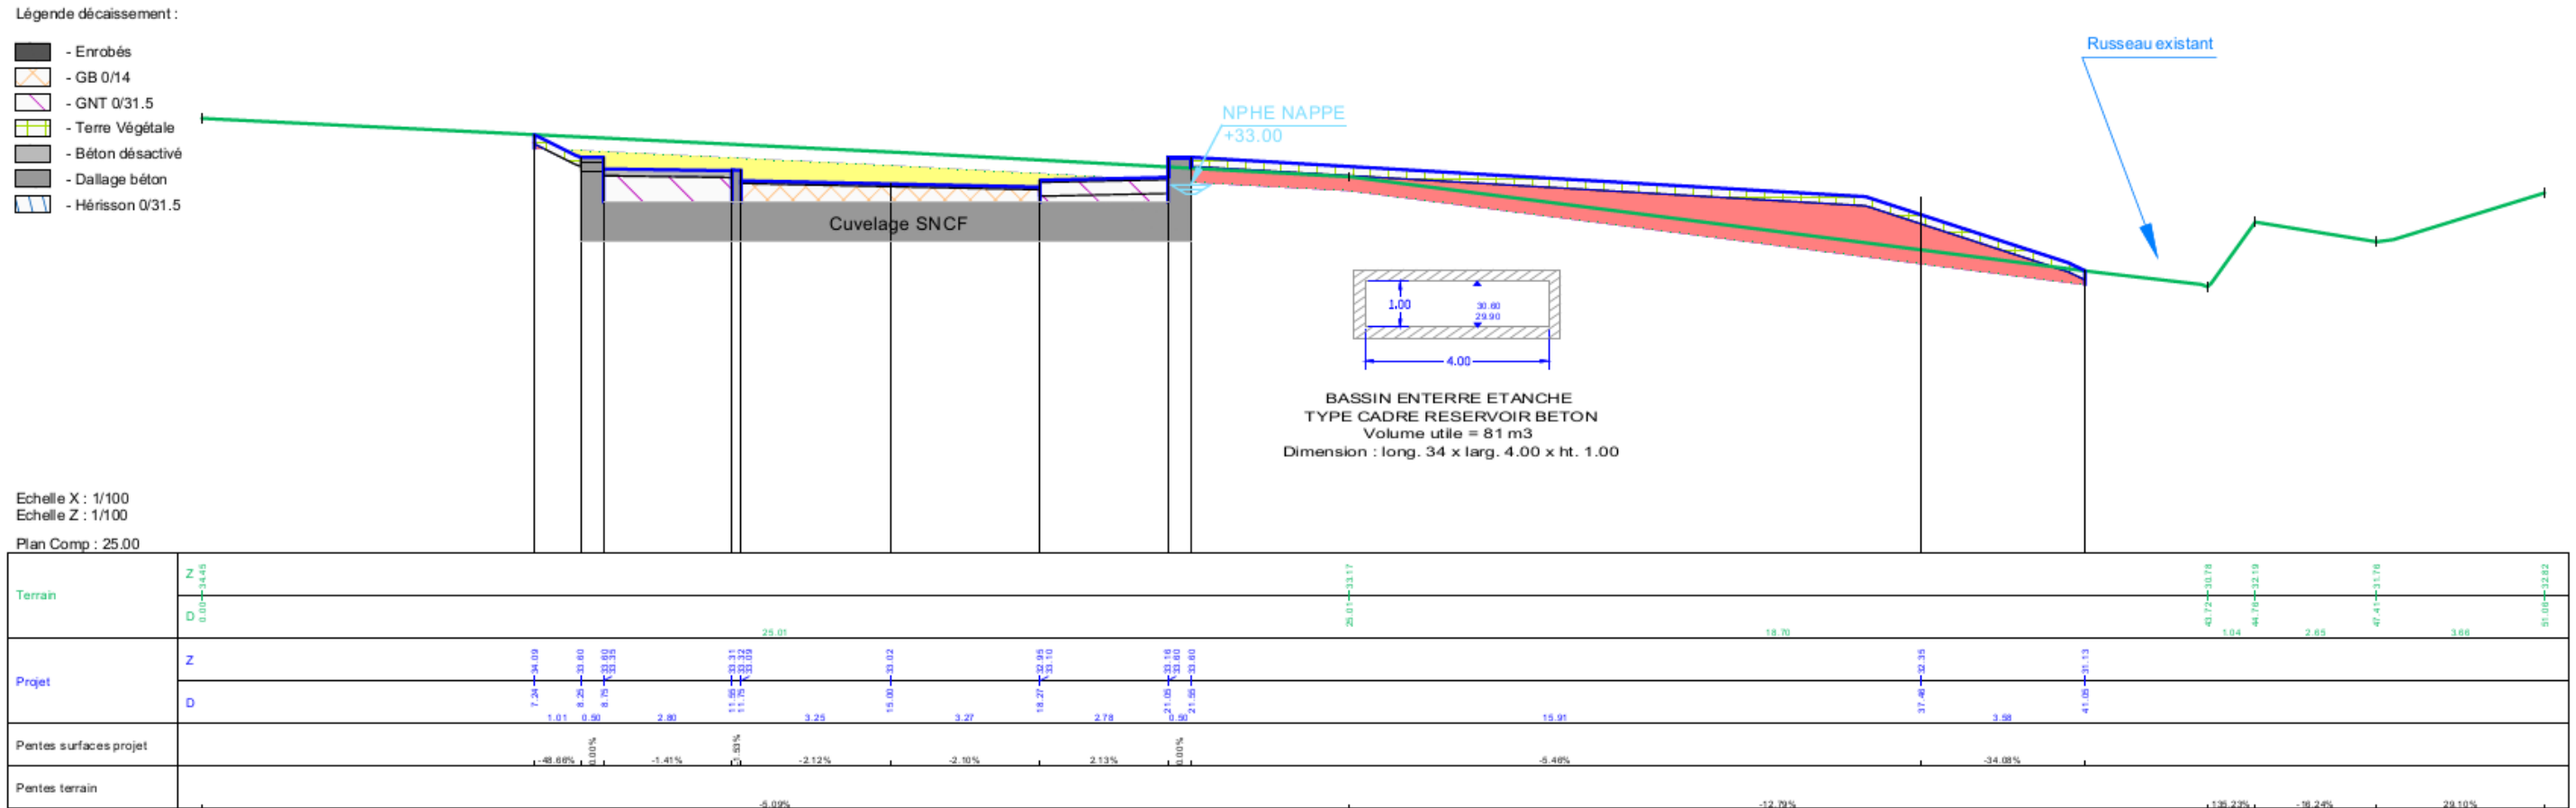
COUPE DU BASSIN DE RETENTION ENTERRE
